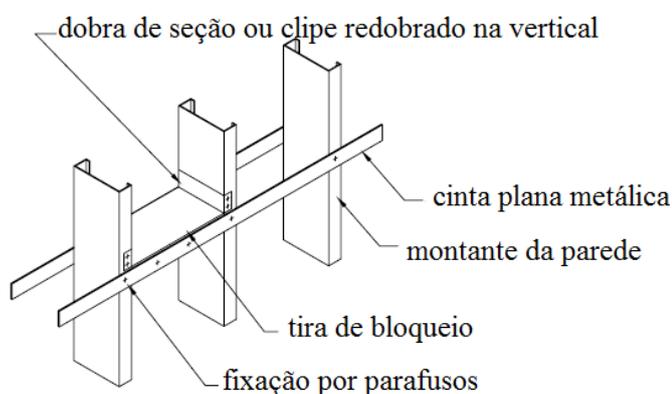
Pormenor construtivo de cintas e bloqueios para contraventamento (NASFA, 2000)
